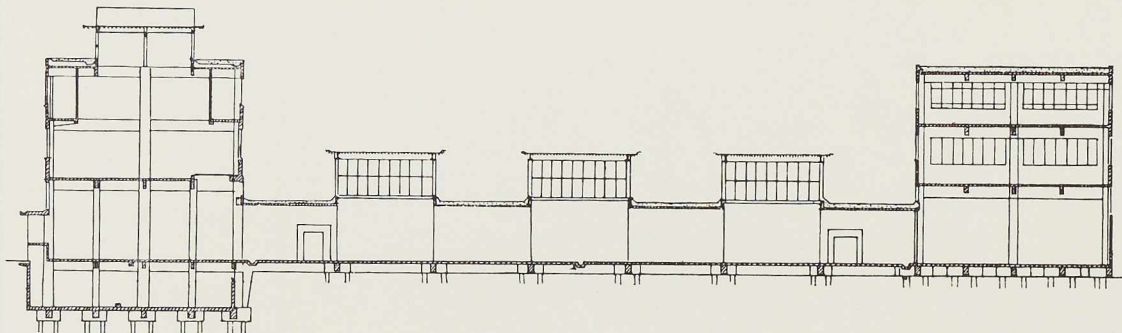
Coupe OP à travers les nouveaux bâtiments.
